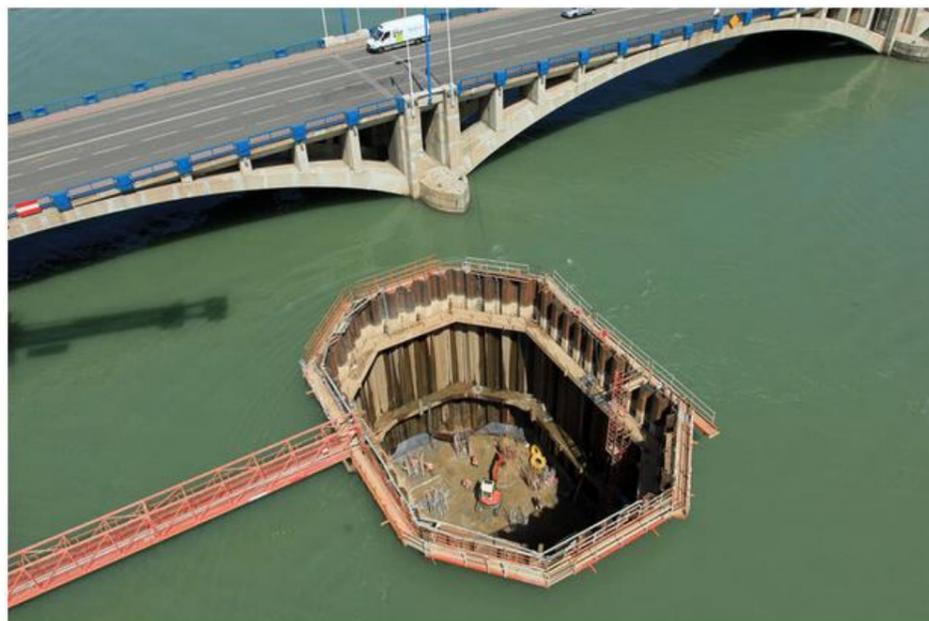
Batardeau pour réalisation d'une fondation dans un cours d'eau
